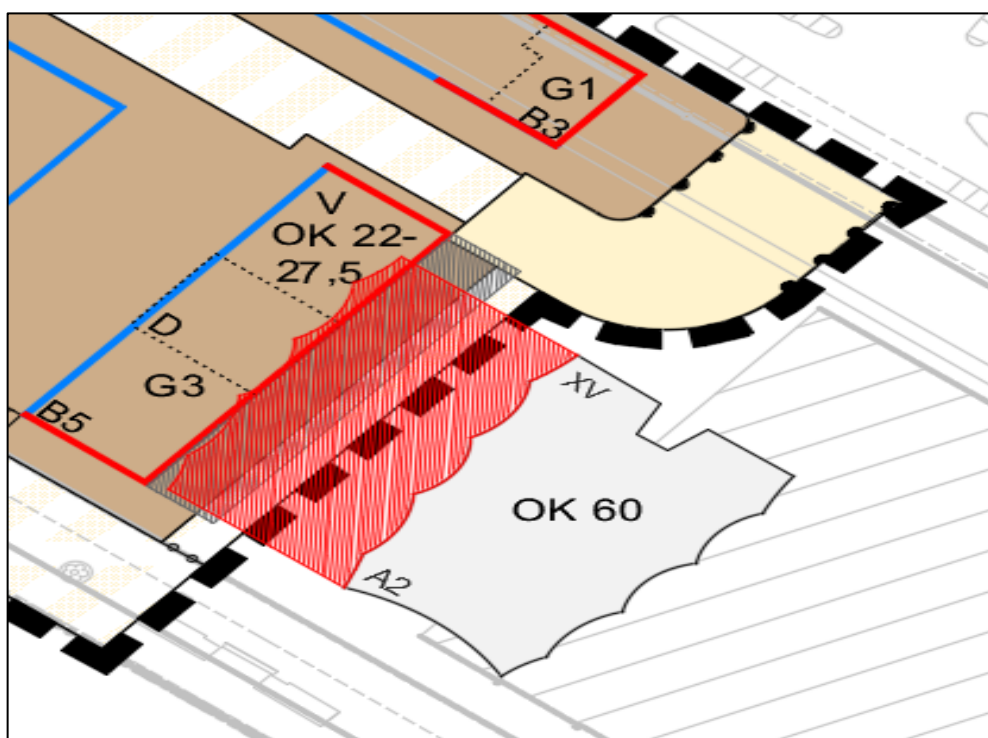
Darstellung der Abstandsfläche (0,4 H) für den im Bebauungsplan 2455 B geplanten Hochpunkt (Gebäude A2) und der Abstandsfläche (0,4 H) für das Baufeld B5
